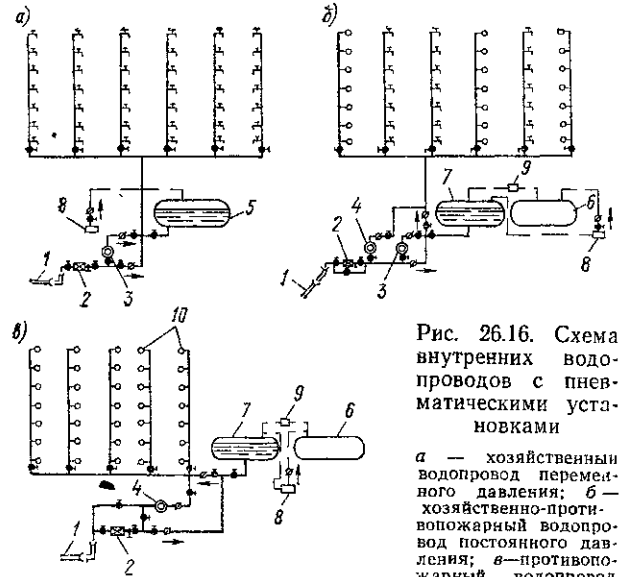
Схема внутренних водопроводов с пневматическими установками
